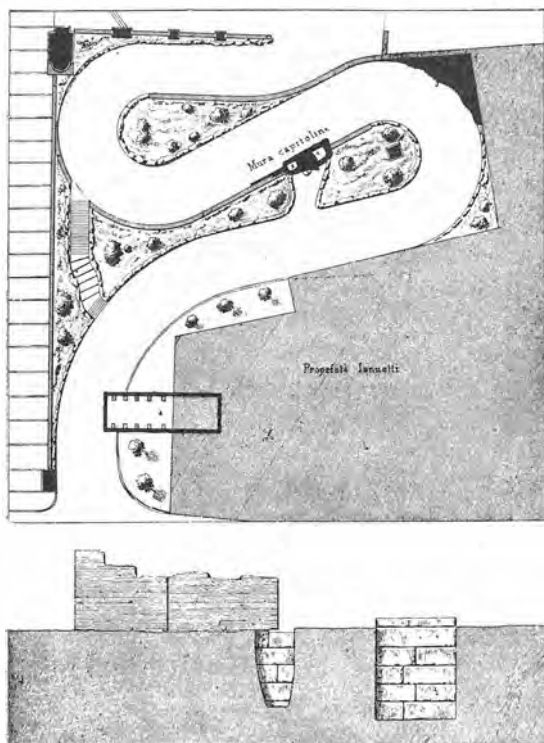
CAP. D. Pianta e prospetto. Scala per il prospetto 1:200 ca. (Bull. com. 1872/3, tav. IV.)
